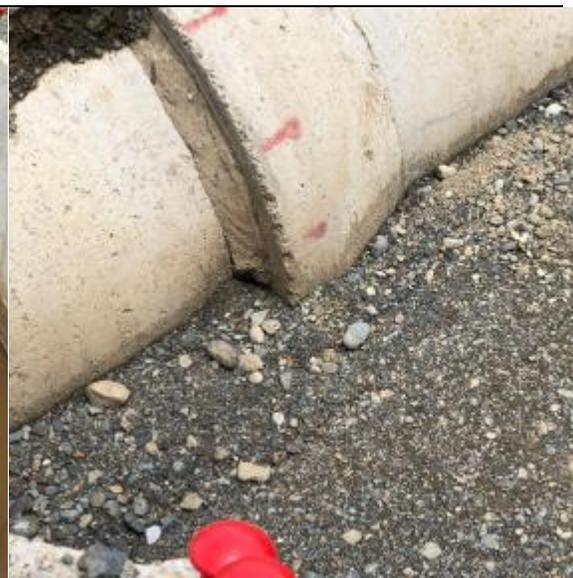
Estructuras de concreto para sistema pluvial.
